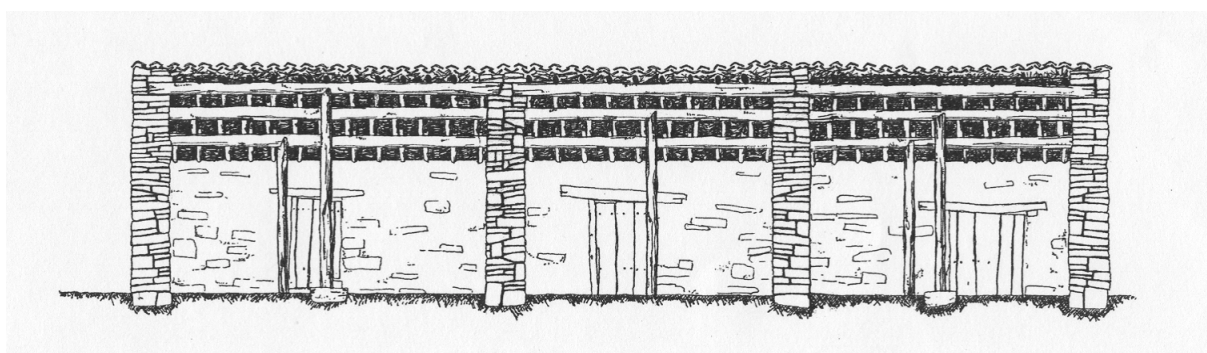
Parideras en Herrería (Guadalajara). Sección transversal. Vista N-S
